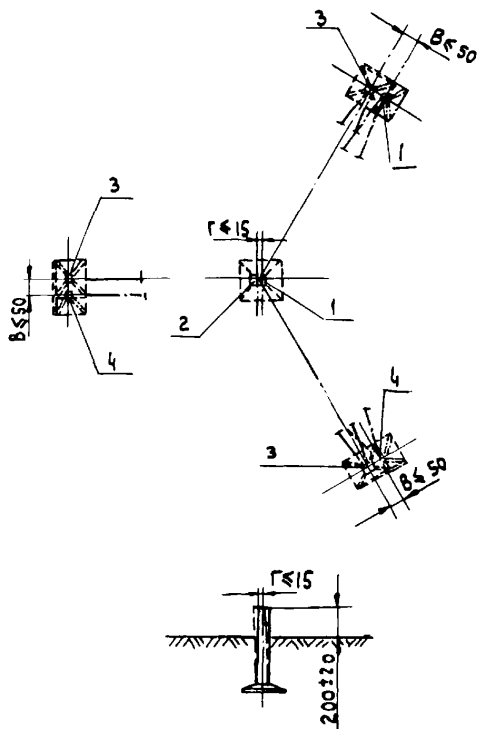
Допуски на установку фундаментов, мм.
